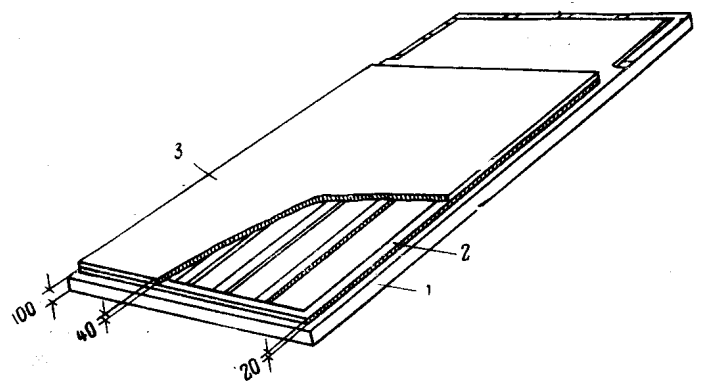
Комплексная панель междуэтажного перекрытия из легкого бетона
